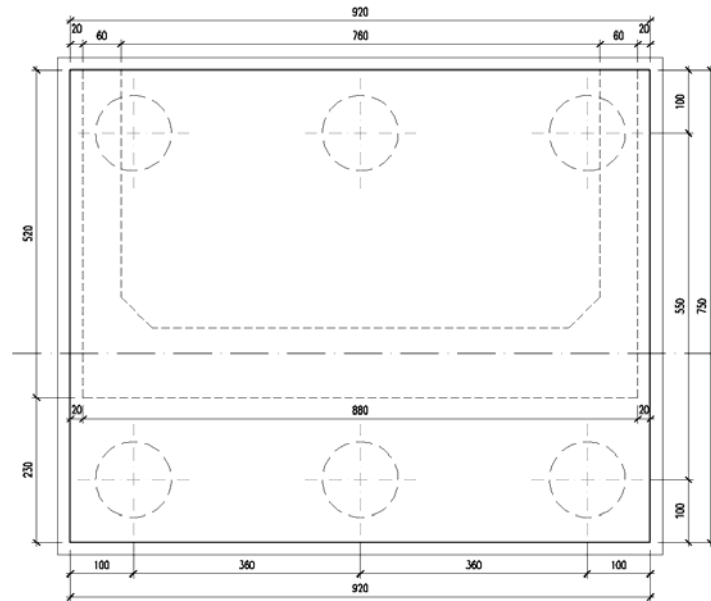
Carpenteria fondazioni della spalla A
